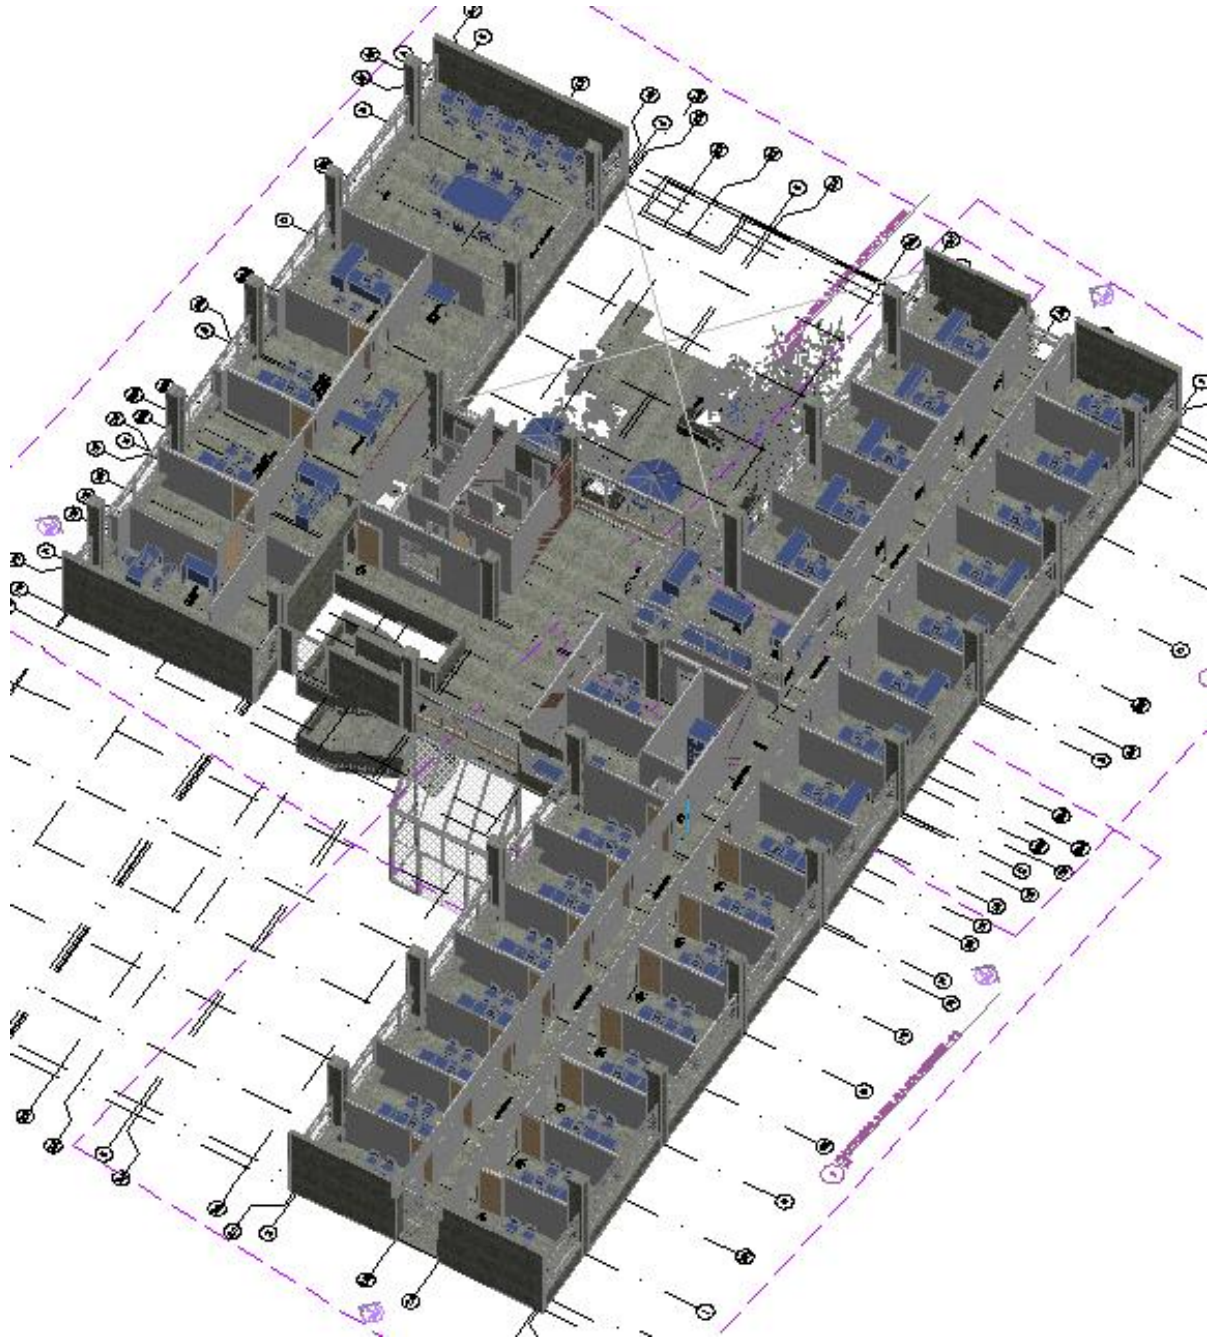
Otro ángulo de la vista arquitectónica del Nivel 2
